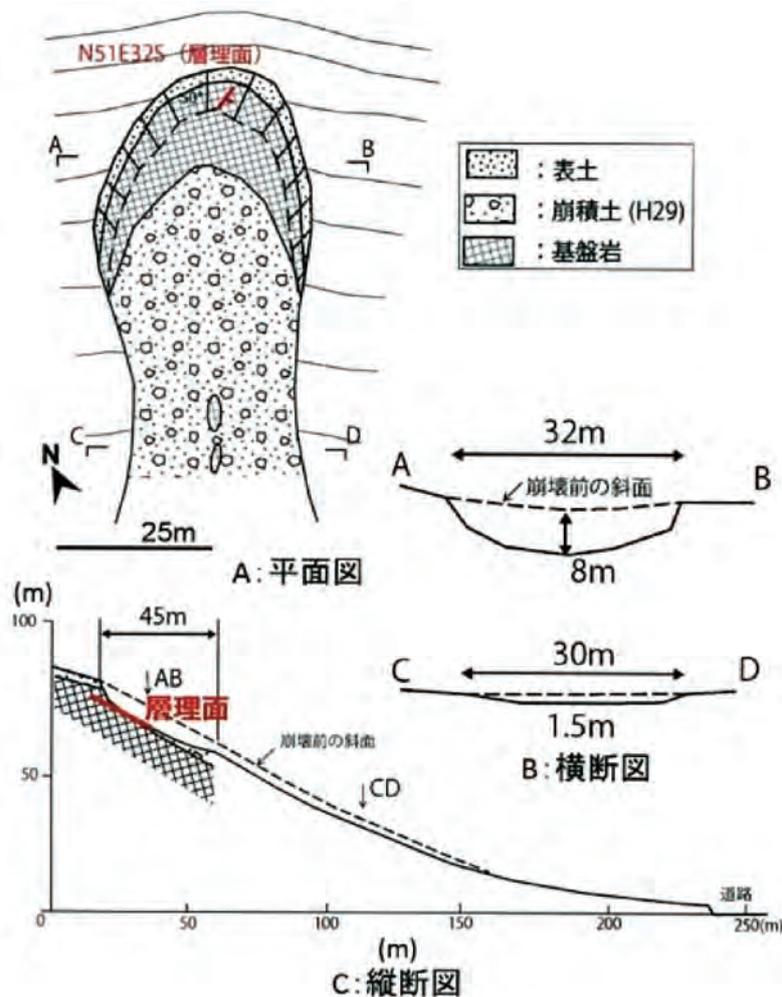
大規模崩壊②の平面図と縦断図¹⁵⁾
